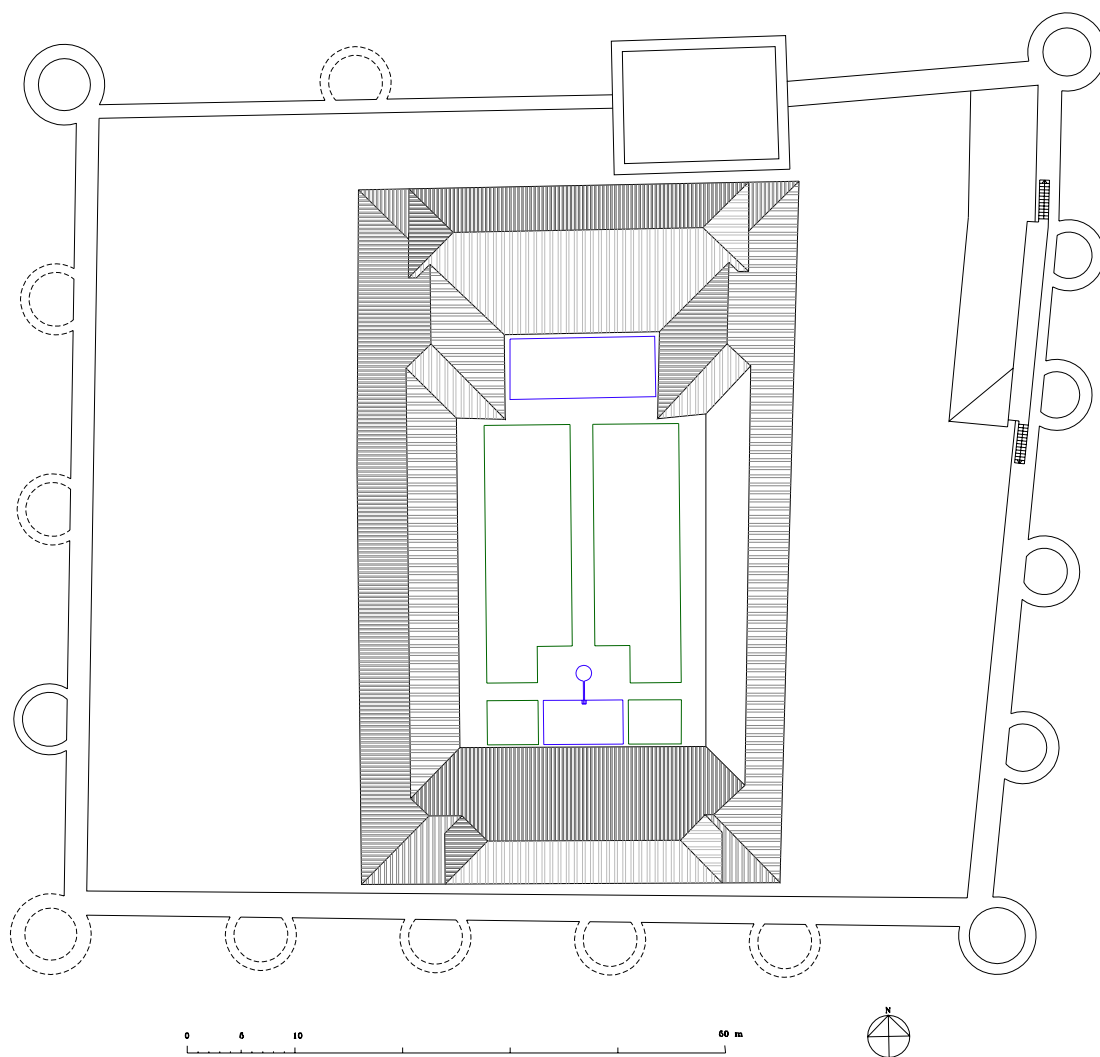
Planta hipotética de cubiertas del palacio taifa
